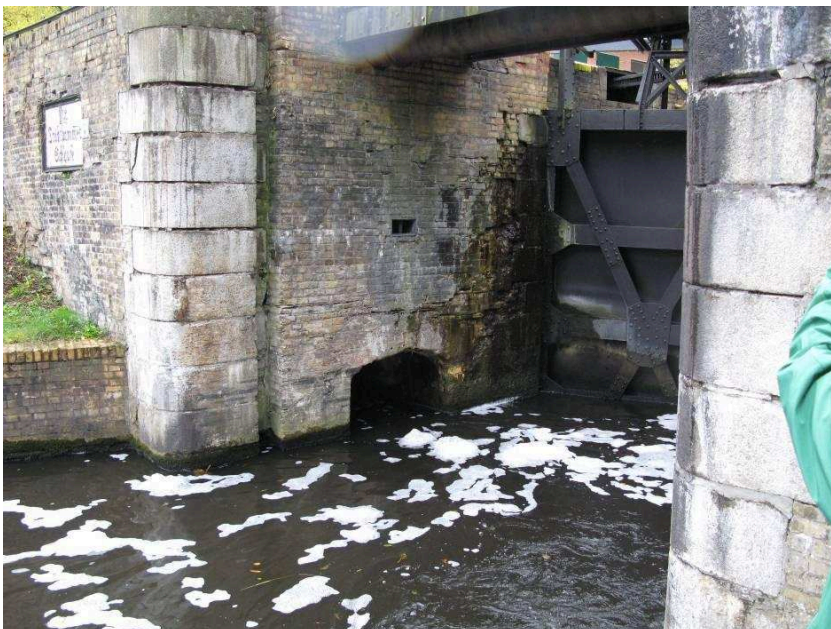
Unterhaupt mit wasserdurchlässigen Fugen, Materialverlust durch Abwitterung und schadhafter Kantensteinenkonstruktion
